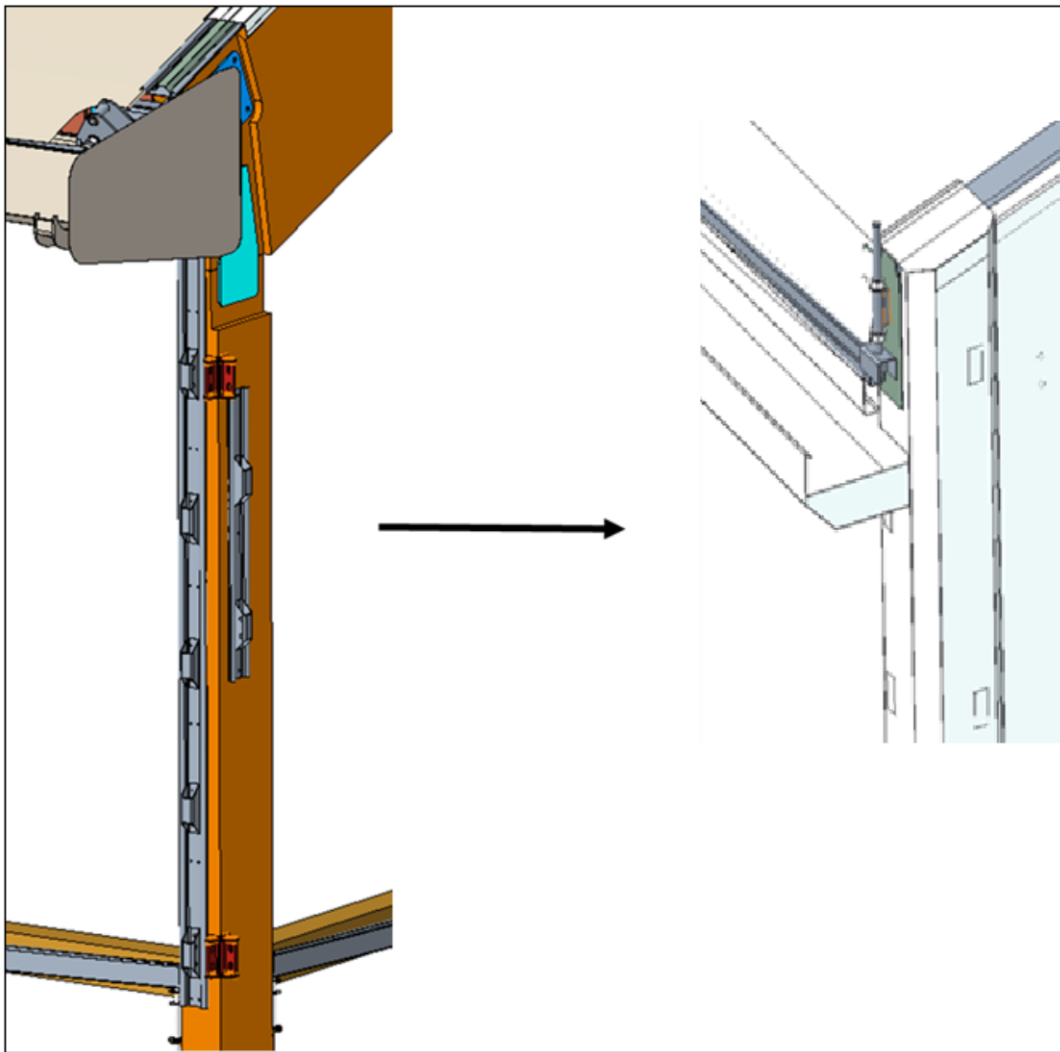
Mise en œuvre des tôles de finition, assurant l'étanchéité en périphérie de la structure, au niveau des poteaux d'angles
